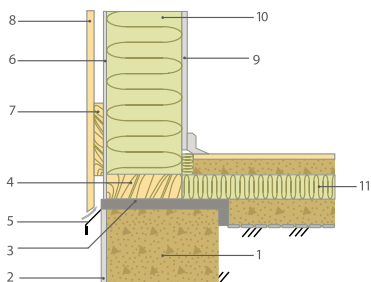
Устройство горизонтальной гидроизоляции каркасно-обшивных стен:
